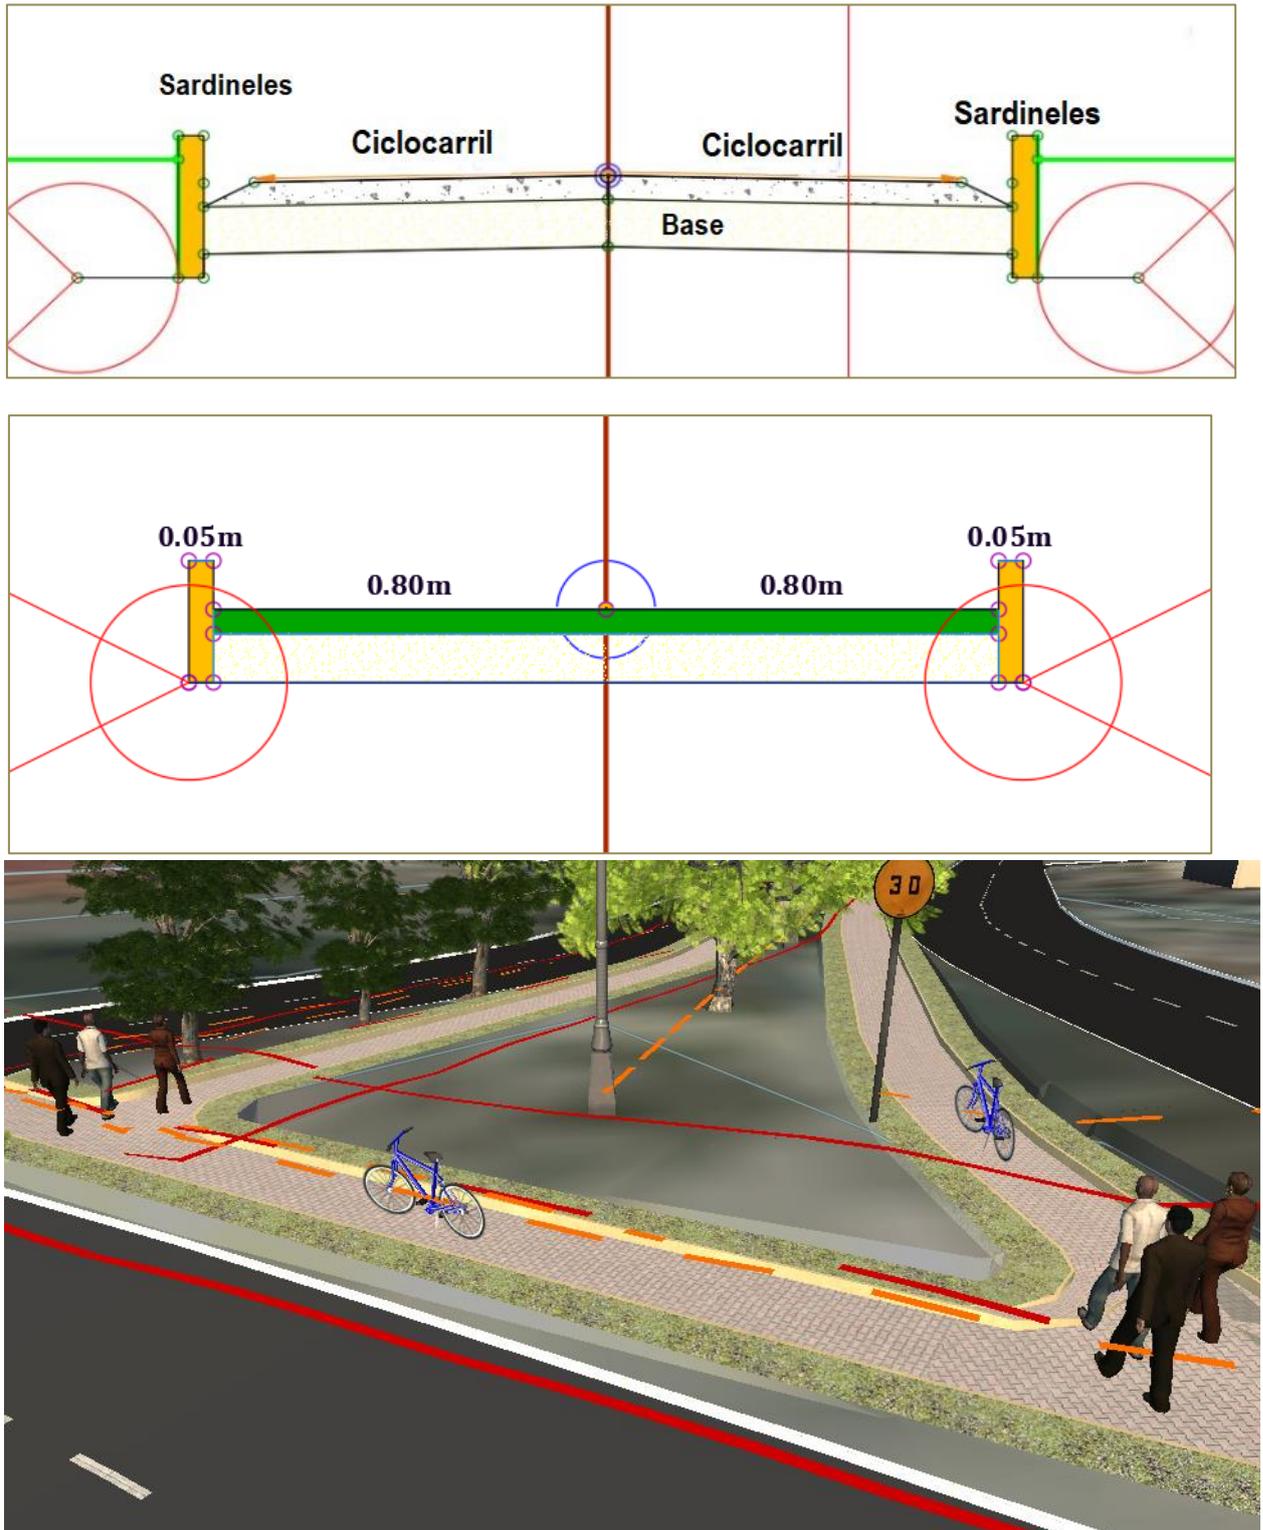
Detalles de la sección transversal del carril de ciclovía.
